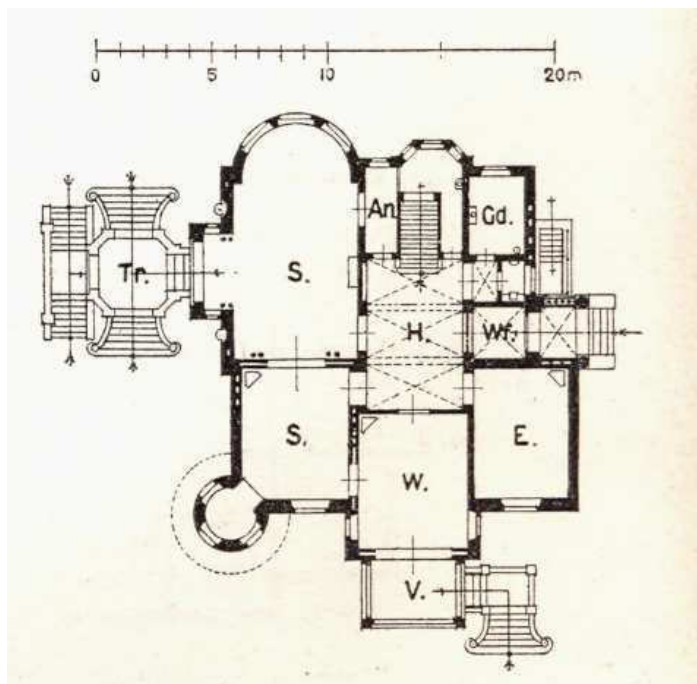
Grundriss von Villa Holthusen, Eichenstraße 48.
